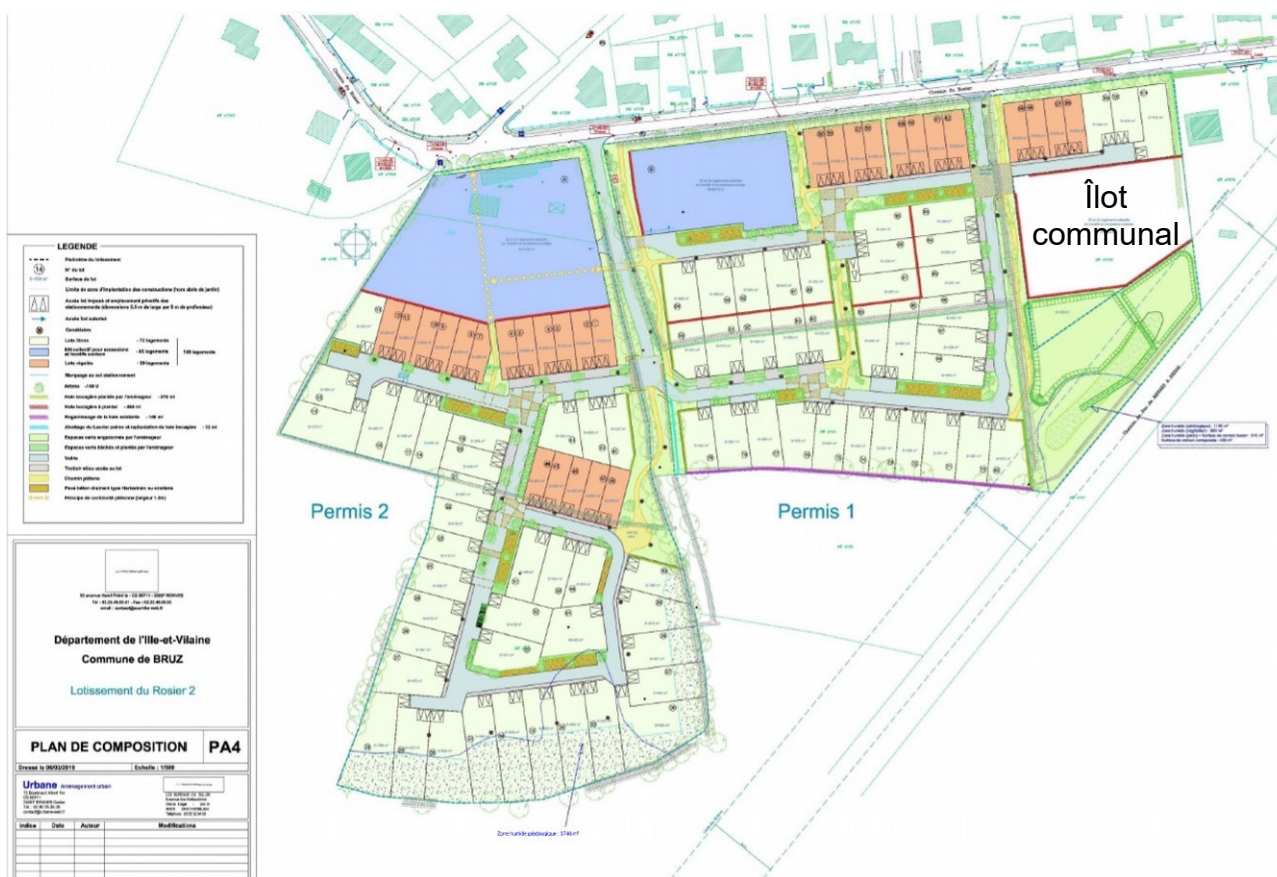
Plan de composition de l'aménagement projeté par l'aménageur Acanthe
